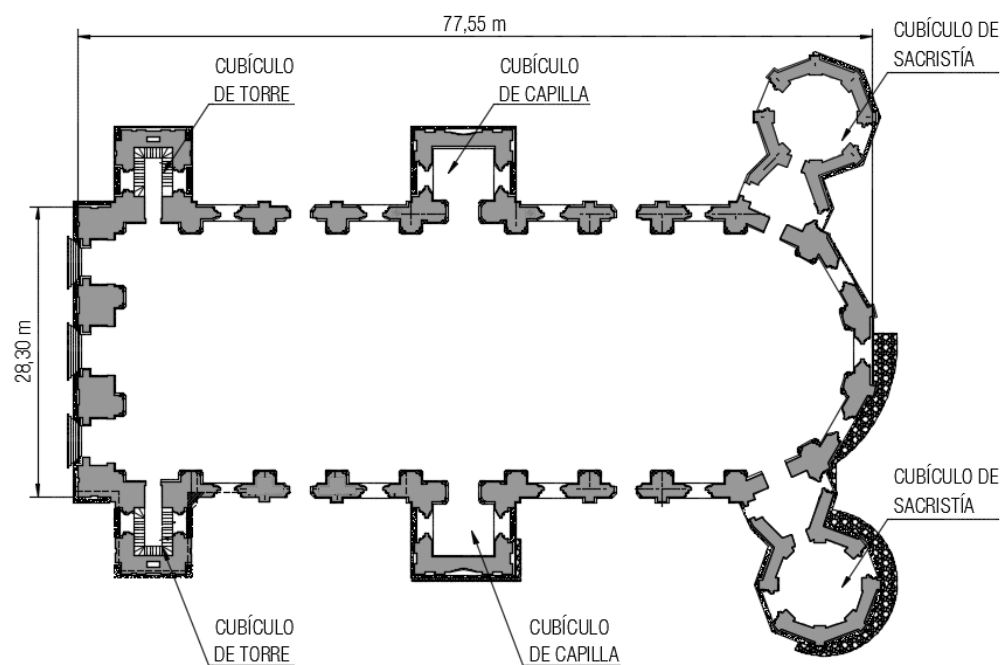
Planta arquitectónica del templo parroquial Santiago Apóstol
